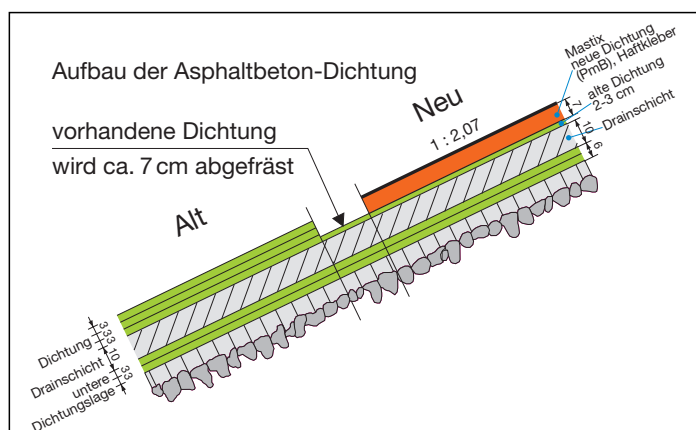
Aufbau der Dichtung vor und nach der Sanierung
